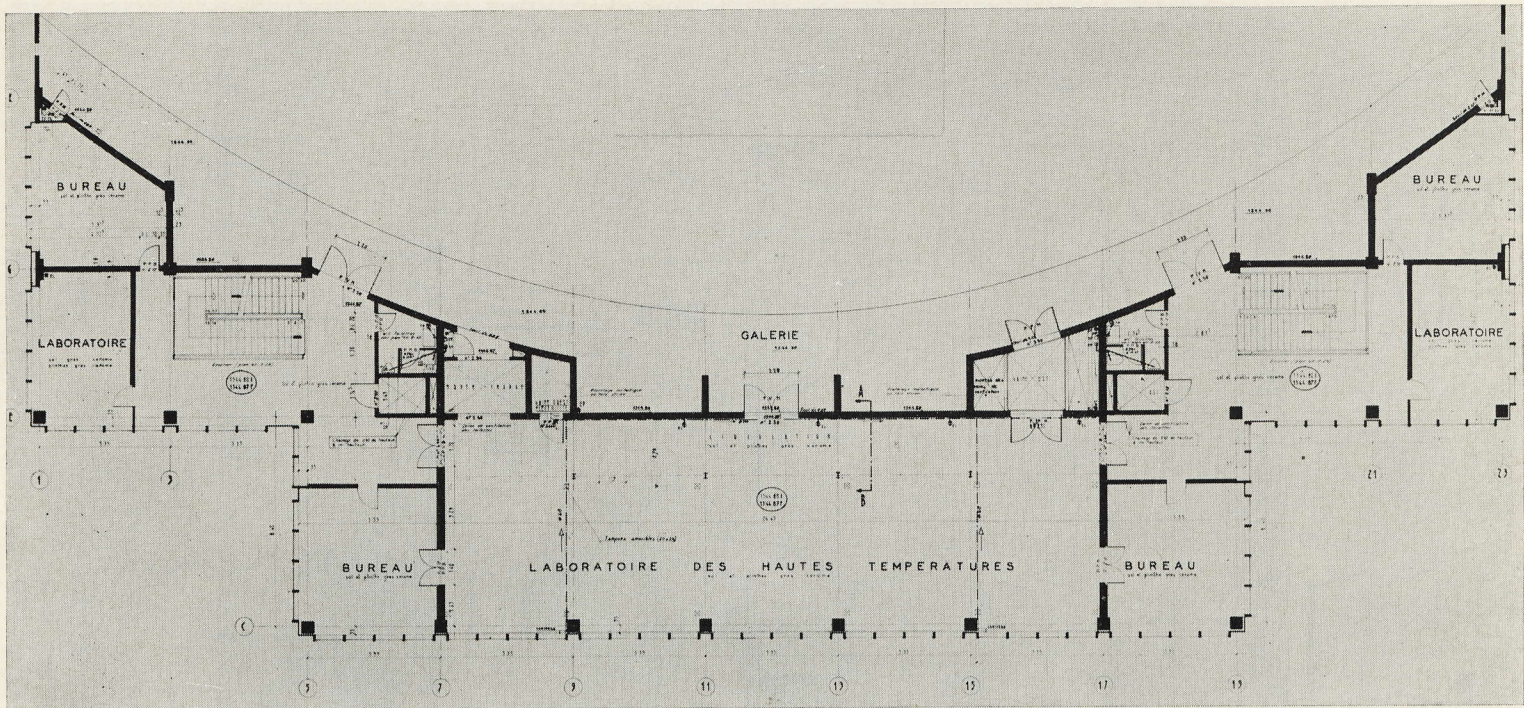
Bâtiment principal-miroir. Plan d'un étage courant.
